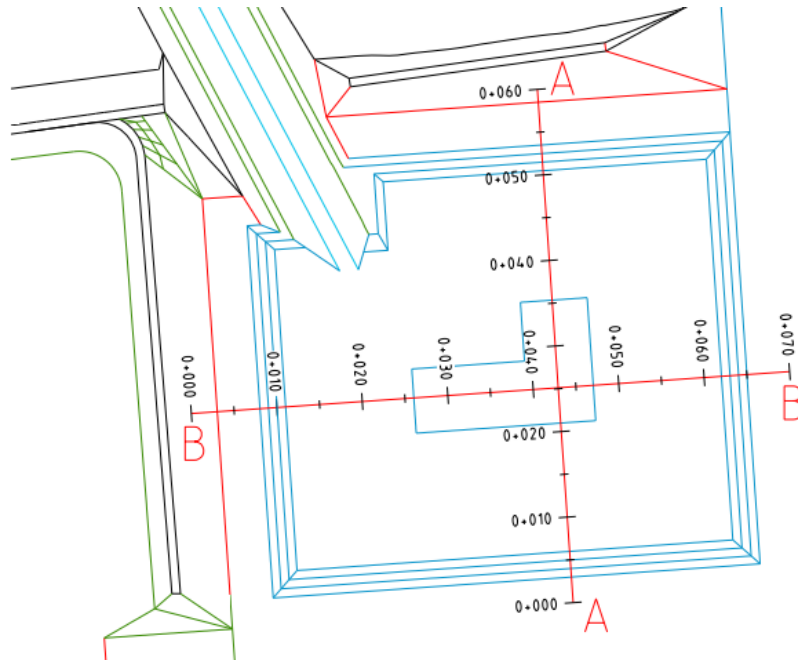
Vue en plan et coupe du bassin de collecte de la plateforme de minerai brut
